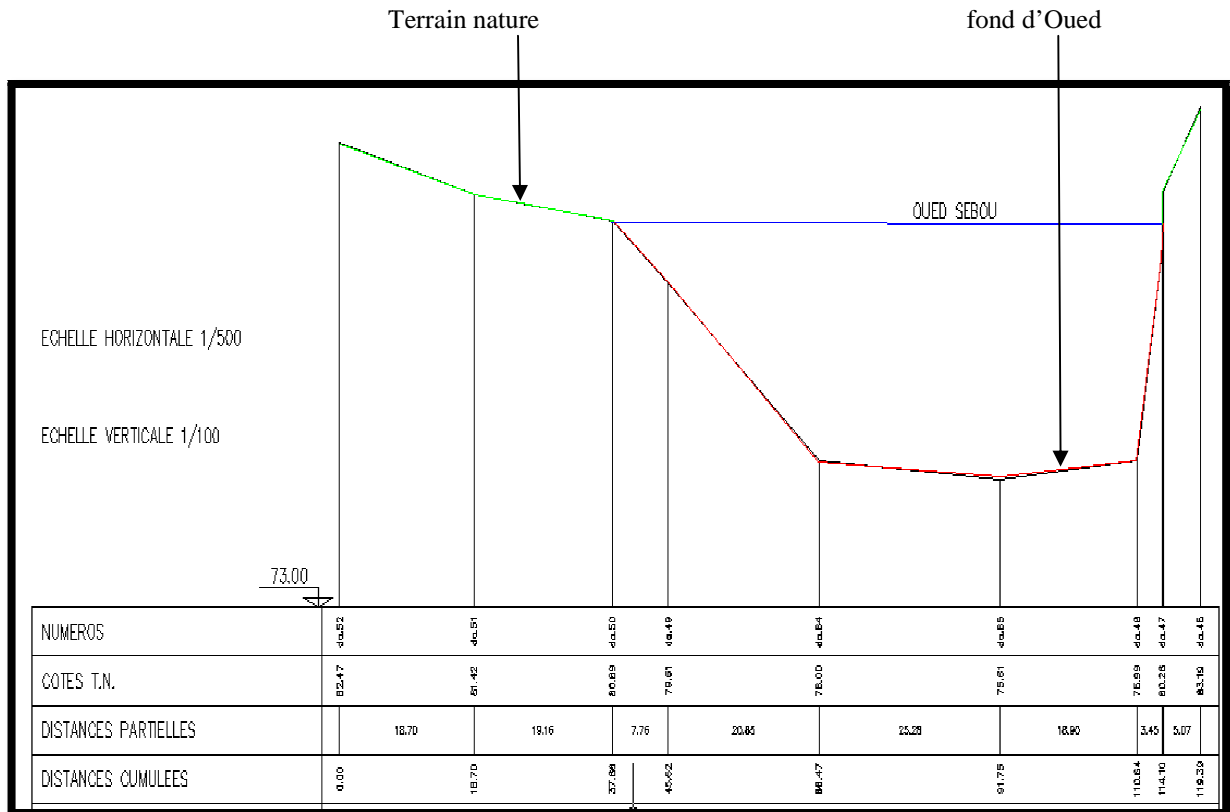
Le profil en travers de la coupe 4 d'Oued Sebou
